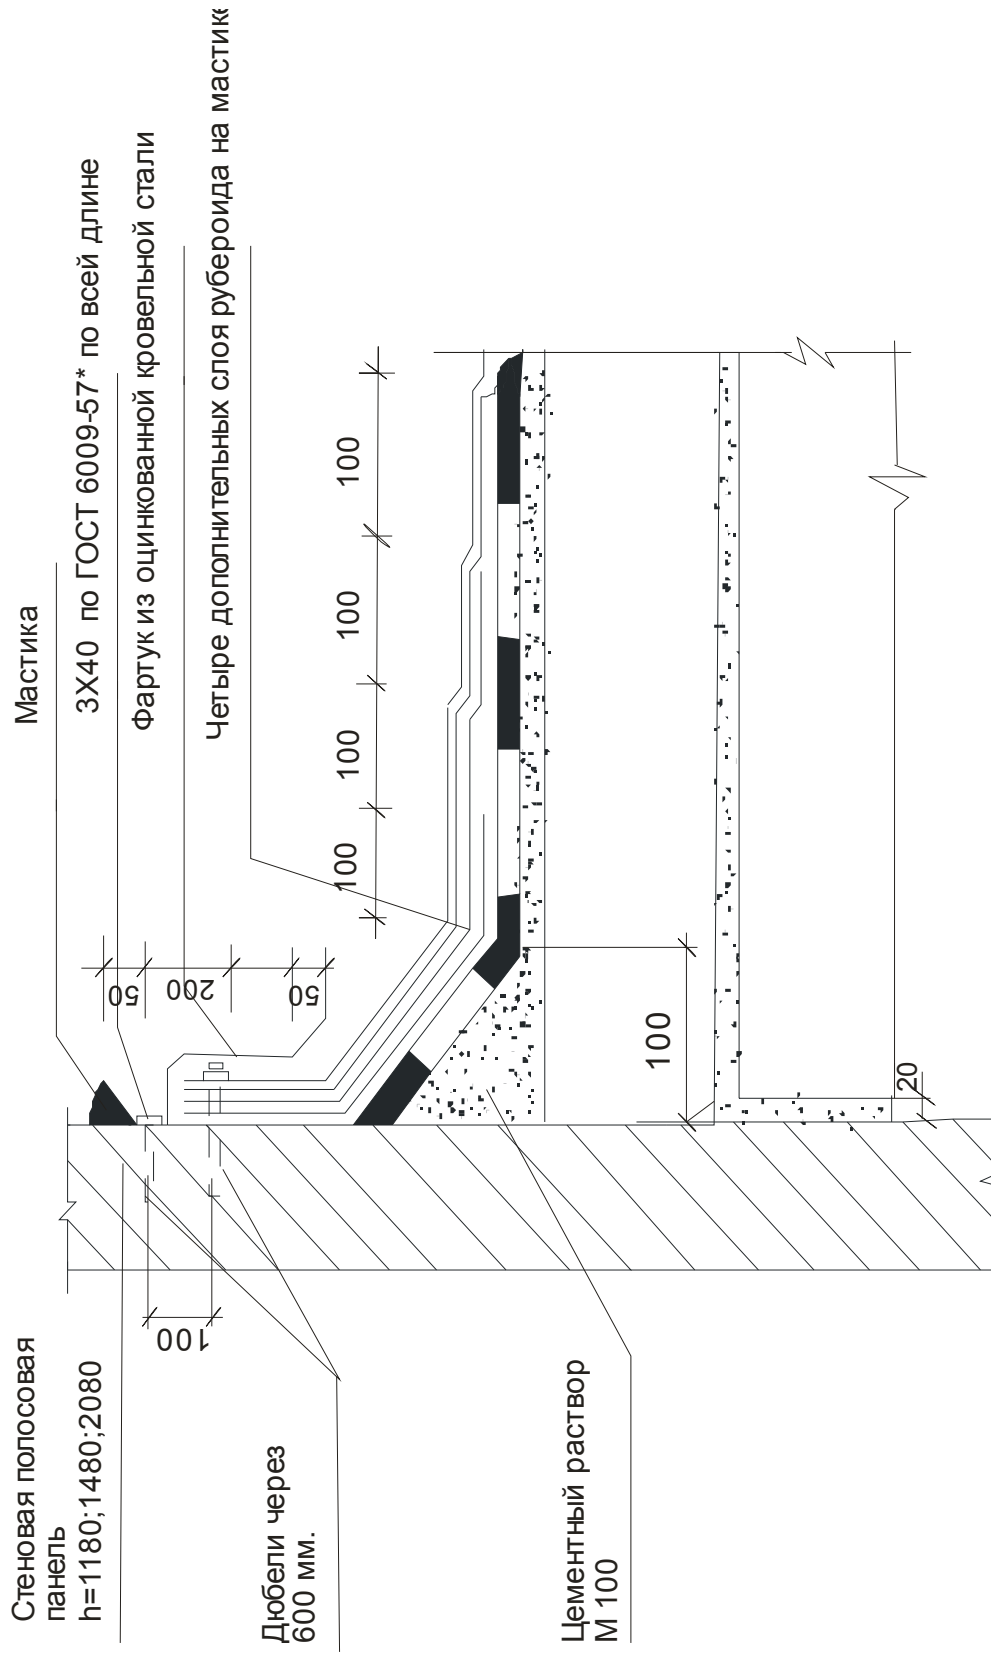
Примыкание кровли к кирпичной или бетонной стене
